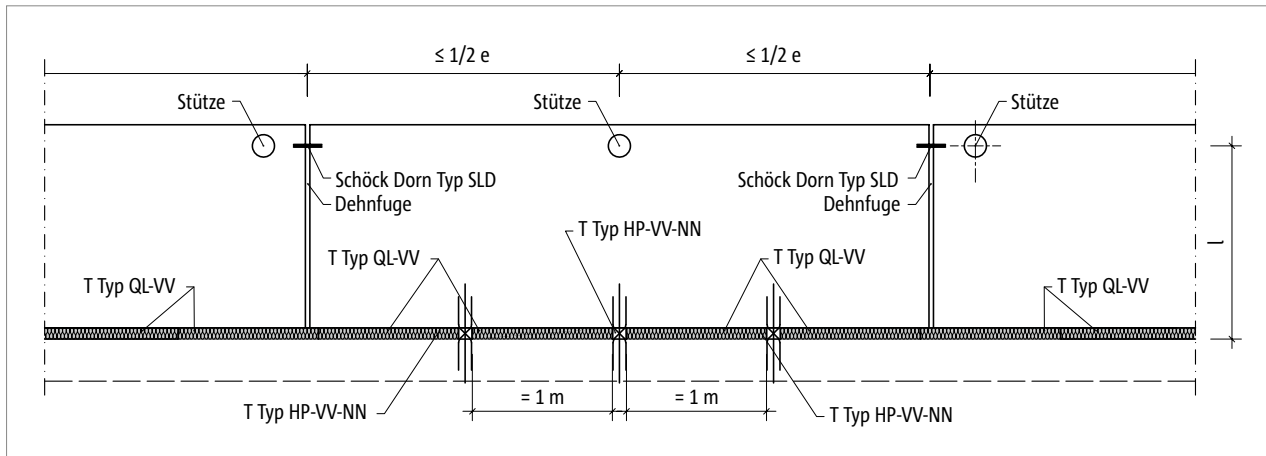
Schöck Isokorb® T Typ HP: Dehnfugenanordnung
